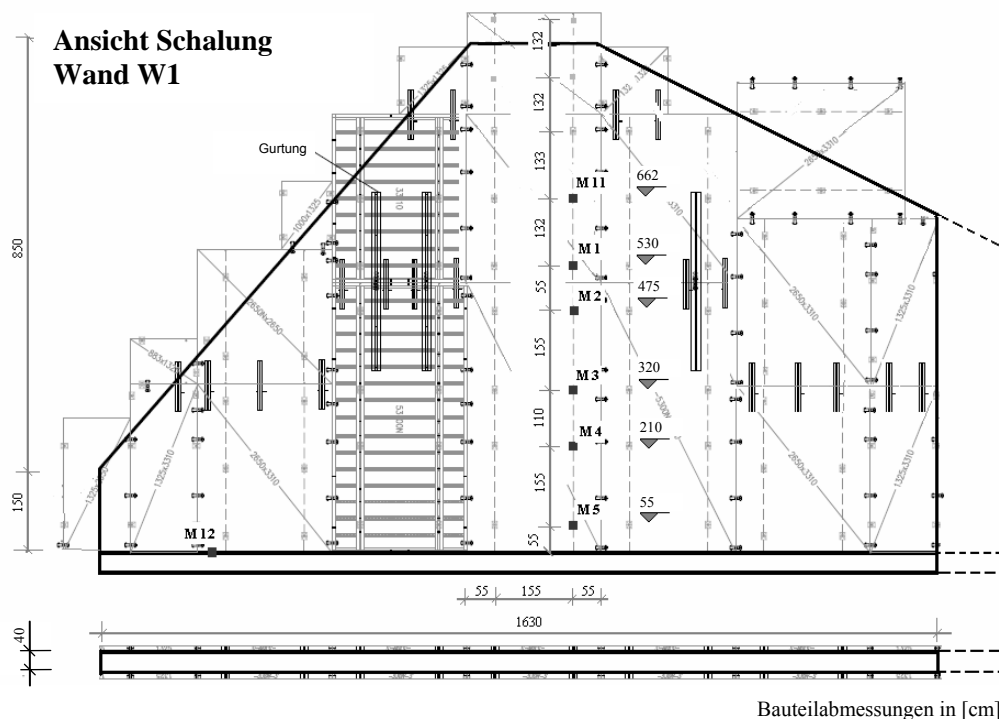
Geometrie der Wand W1, Schalungsplan mit Anordnung der Messpunkte
